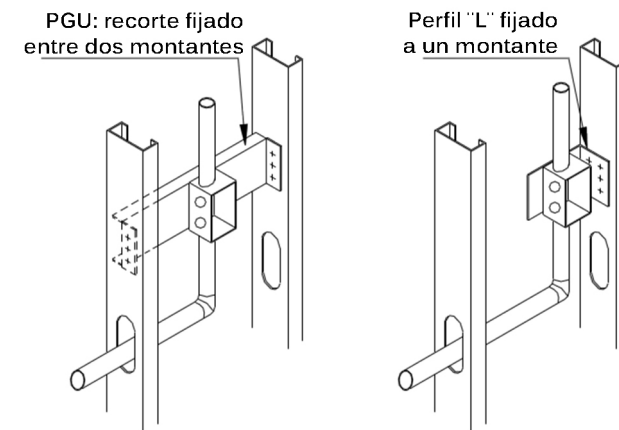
Detalle de la Instalación de tuberías.
